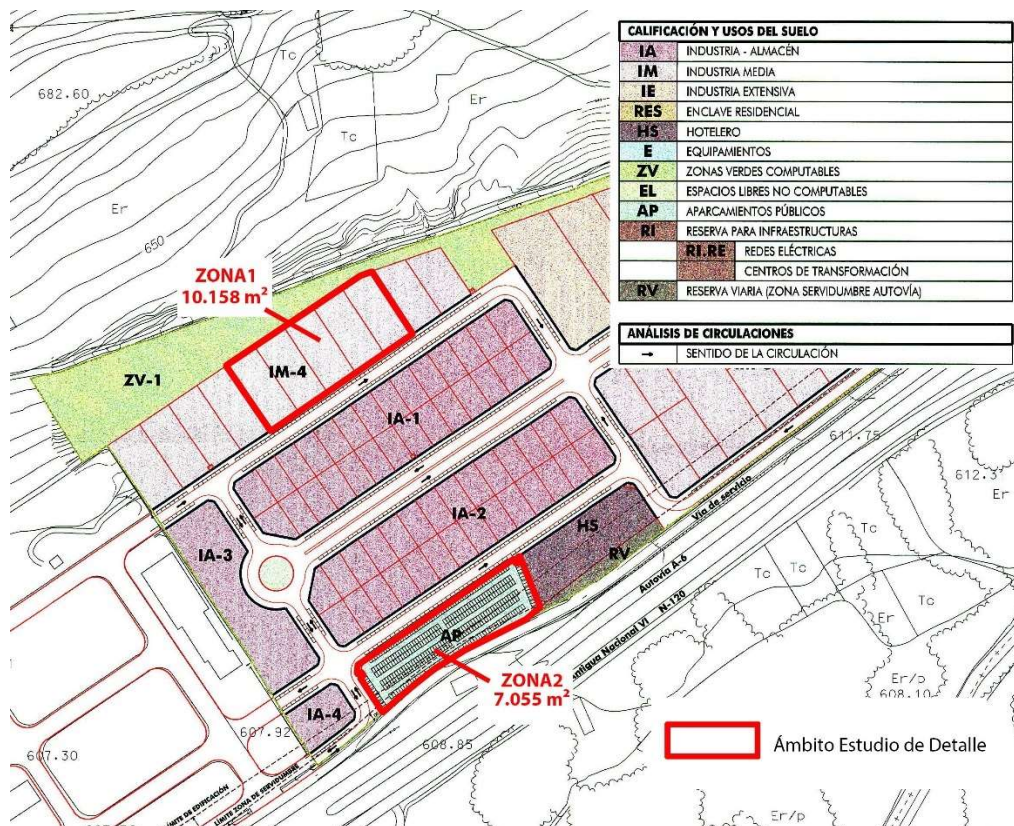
Plano 1 Calificación. Ordenación vigente.
